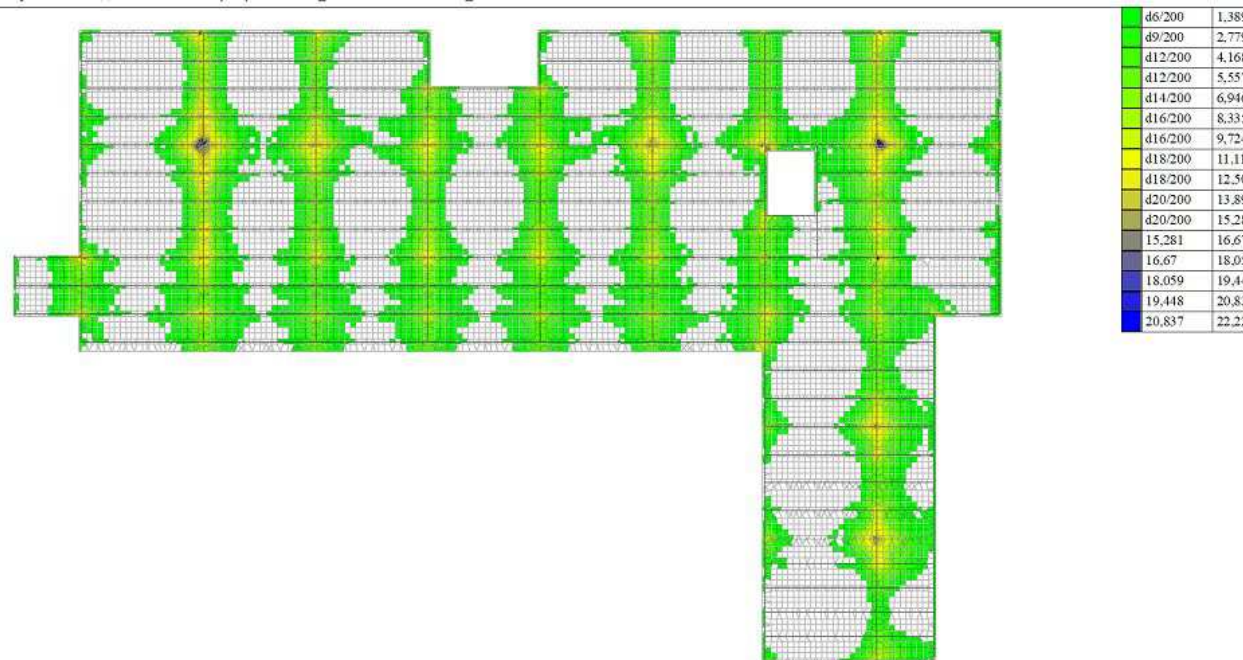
Схема верхнего армирования плиты по оси x
